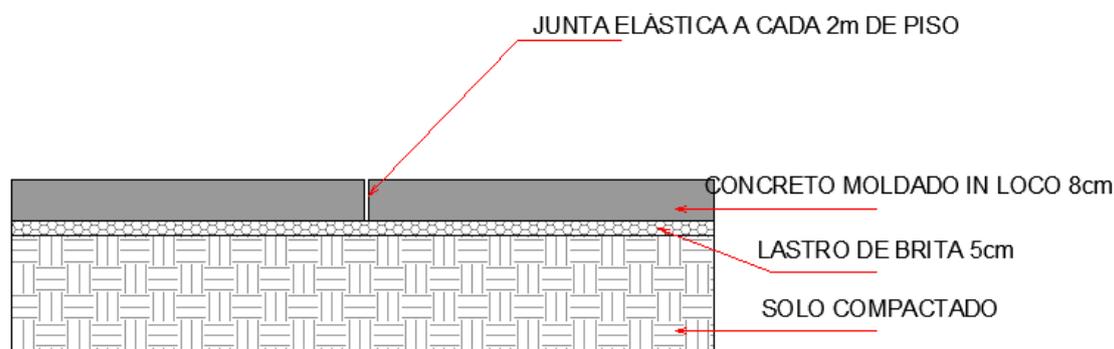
CORTE ESQUEMÁTICO JUNTAS DE DILATAÇÃO – CALÇADA EM CONCRETO
